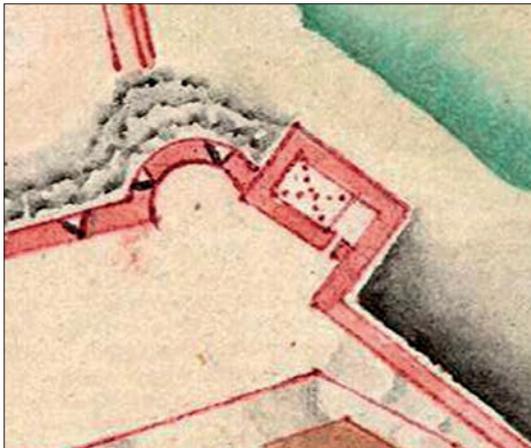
DETALLE DE LA PLANTA DEL REPUESTO DE PÓLVORA DE LA BATERÍA REAL, EN UN PLANO DE MELILLA DE 1735. Archivo General de Simancas, MPD-60-053.
